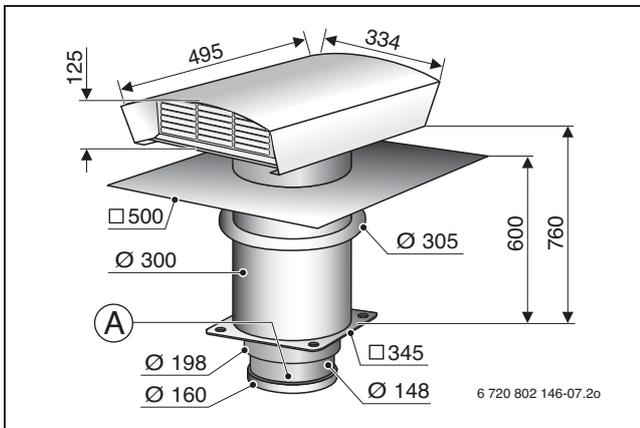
Dimensioni bocchetta a tetto DDF 160/1 (dimensioni in mm)
